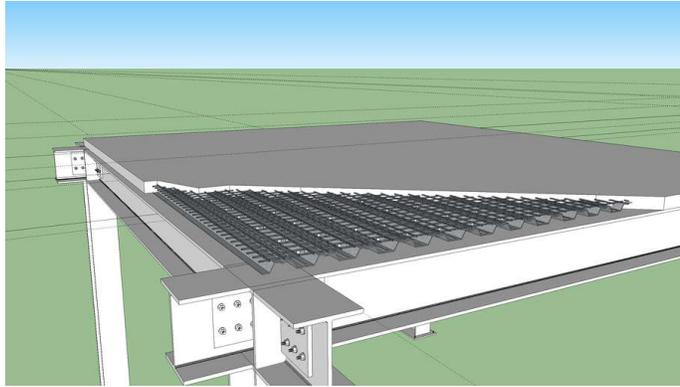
Cubiertas de Acero. Tomado de <https://3dwarehouse.sketchup.com>
